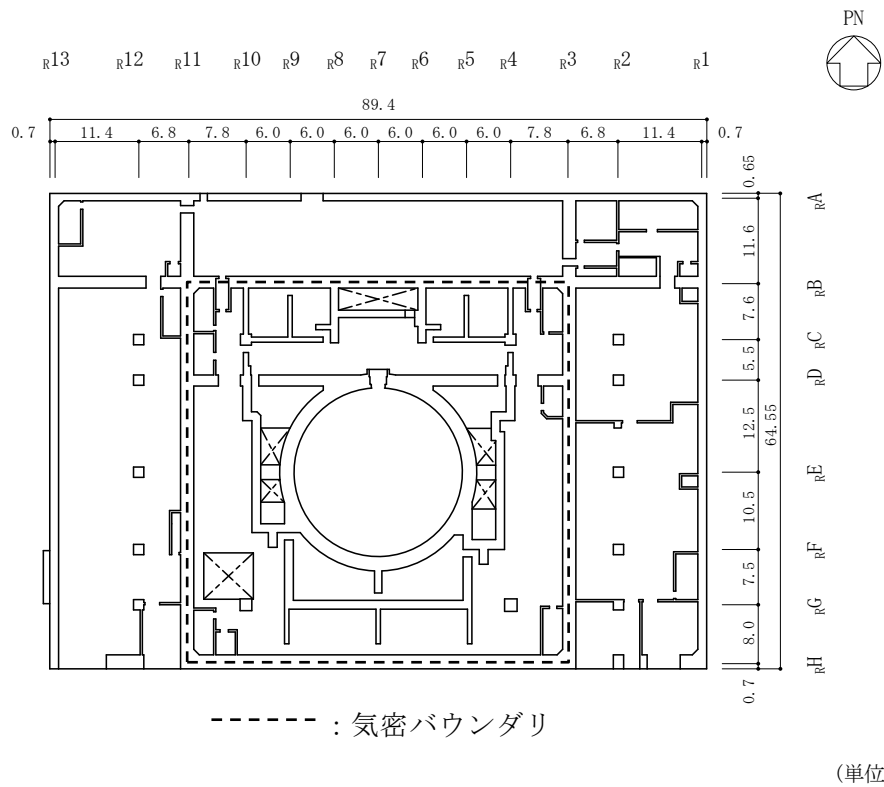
(4) 原子炉建物原子炉棟（二次格納施設）の概略平面図（EL 23.8m）
